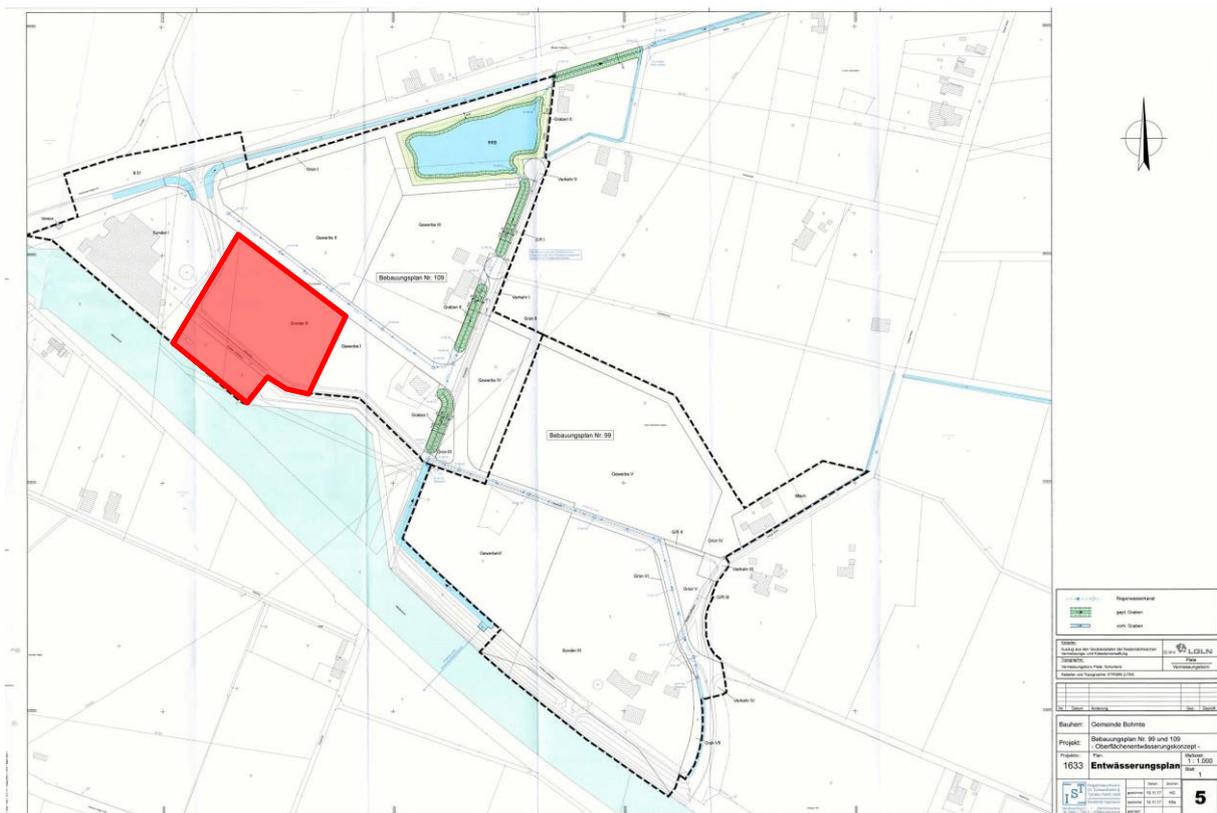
Entwässerungsplan B-Plan Nr. 99 und B-Plan Nr. 109 (IST 2017), verändert: rote Fläche = Bereich der 1. Änderung des B-Plan Nr. 109)
